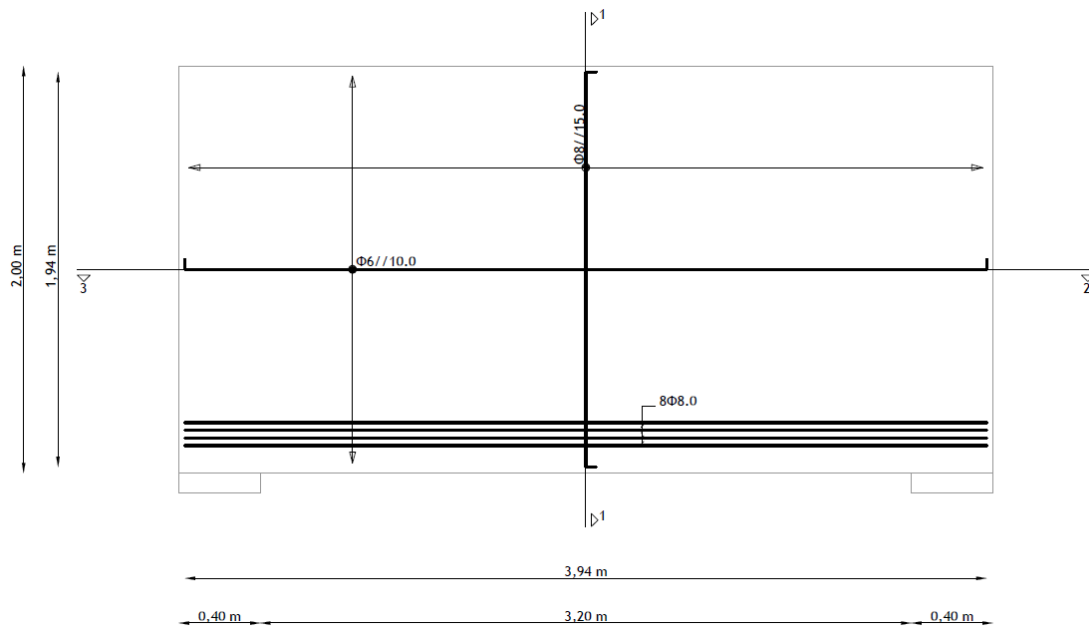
Vista em alçado da pormenorização das armaduras principais e suplementares relativas à viga parede.
